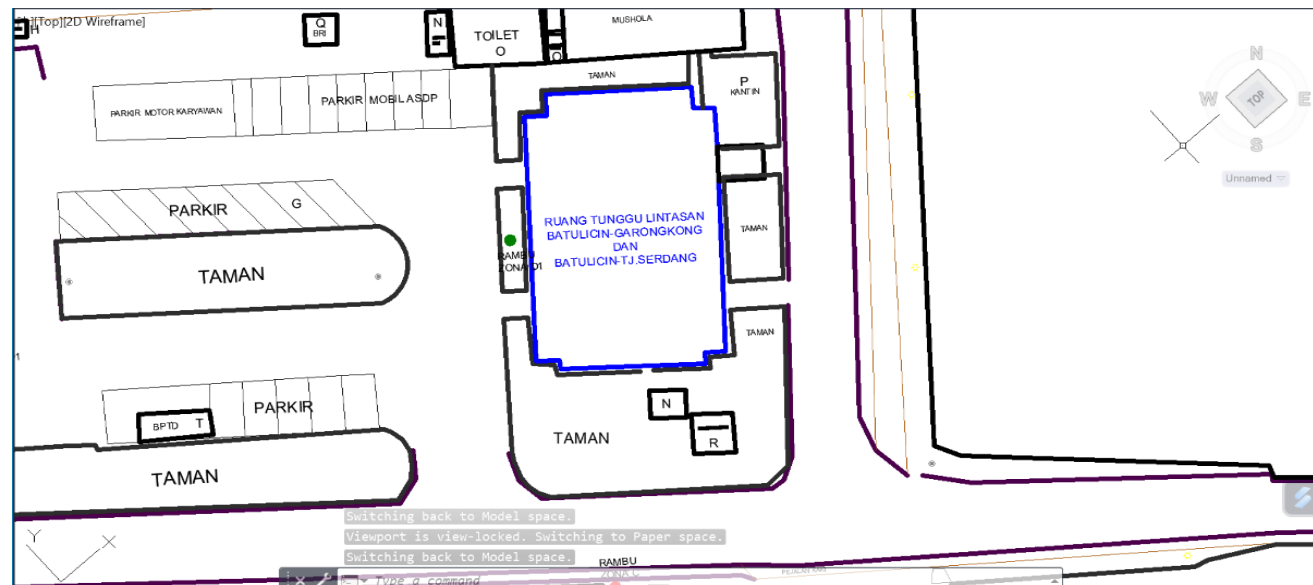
63 *Layout* Perencanaan Fasilitas yang Baru
